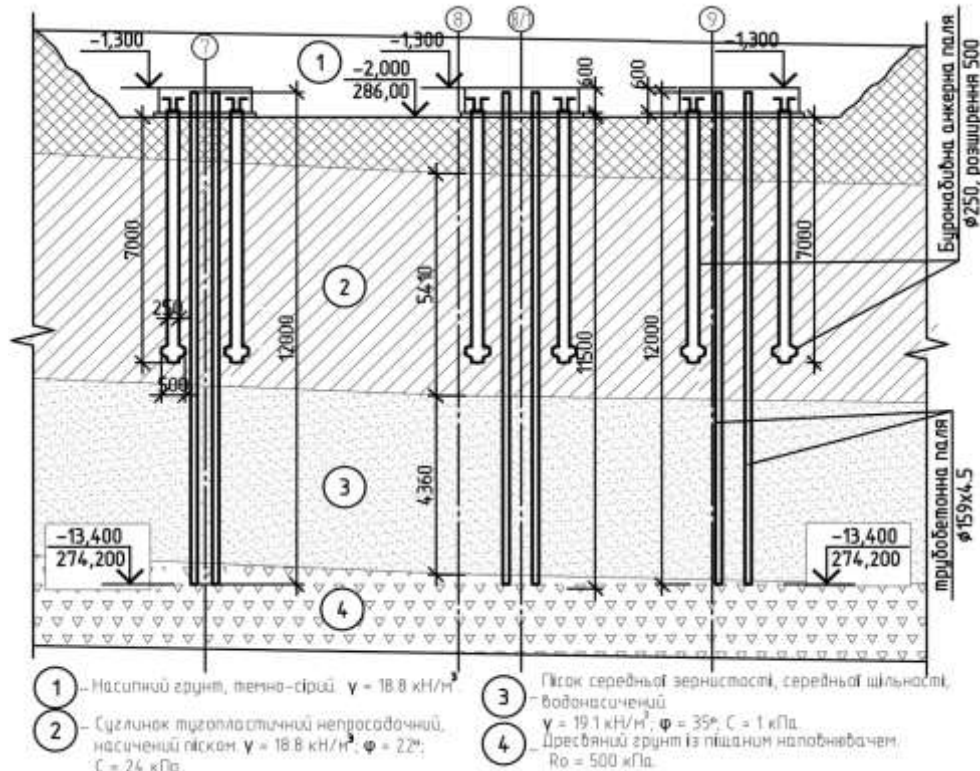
Посадка на геологію фундаментів по розрізу 1-1.
